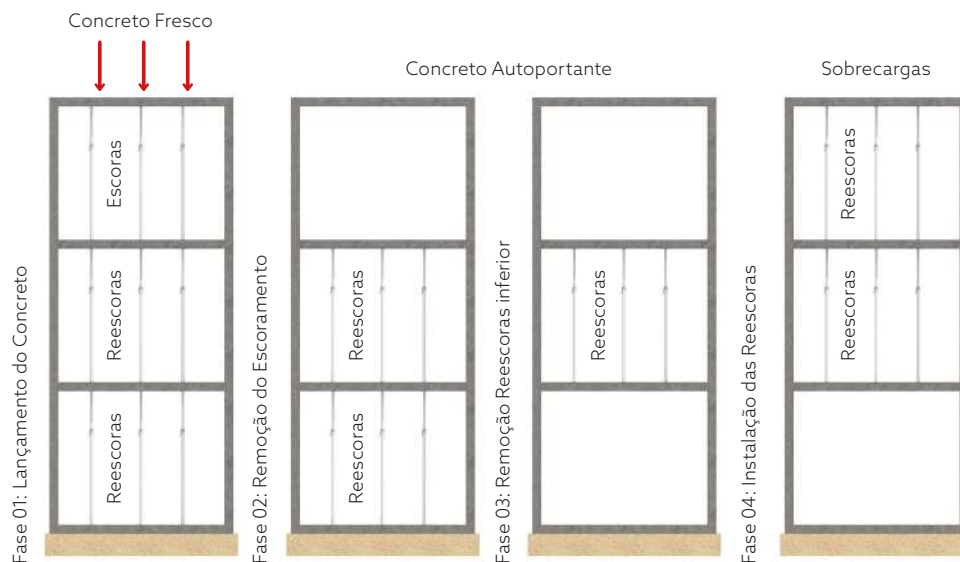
Fase de construção típica para edifícios de concreto armado de múltiplos pavimentos conforme ACI347.2R-5
